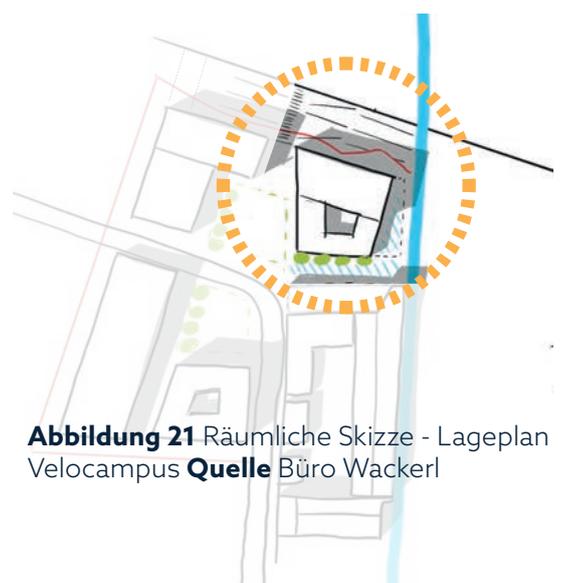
Räumliche Skizze - Lageplan Velocampus. Quelle Büro Wackerl
